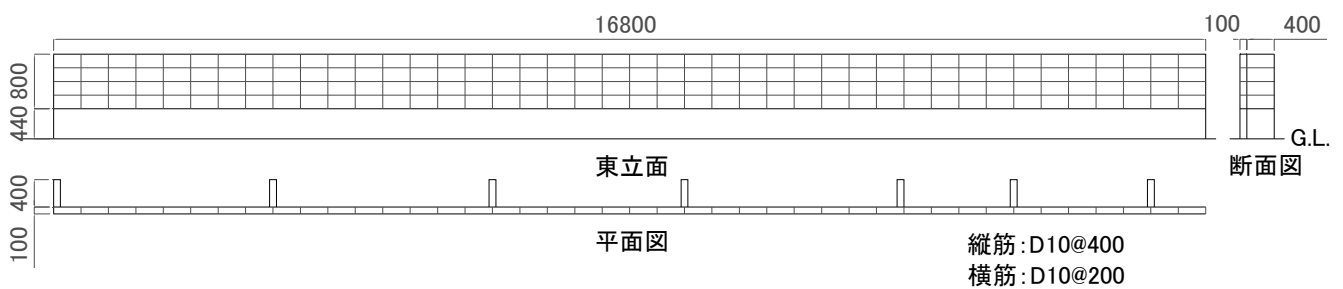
CB 塀の立面図・平面図 (単位: mm)
